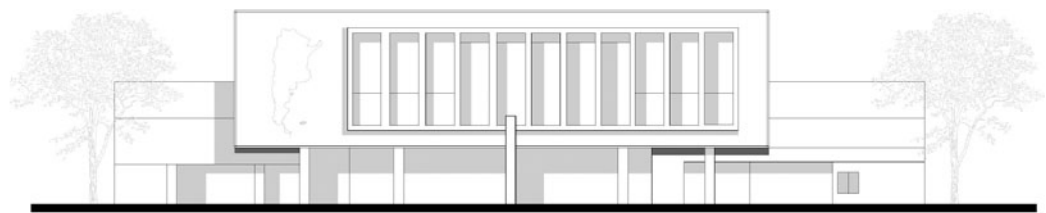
Fachadas del conjunto Aca en Mar del Plata. Proyecto original. Fuente: Juan Pablo Zalazar y Omar Darío Nogara (redibujado del original) 2013
